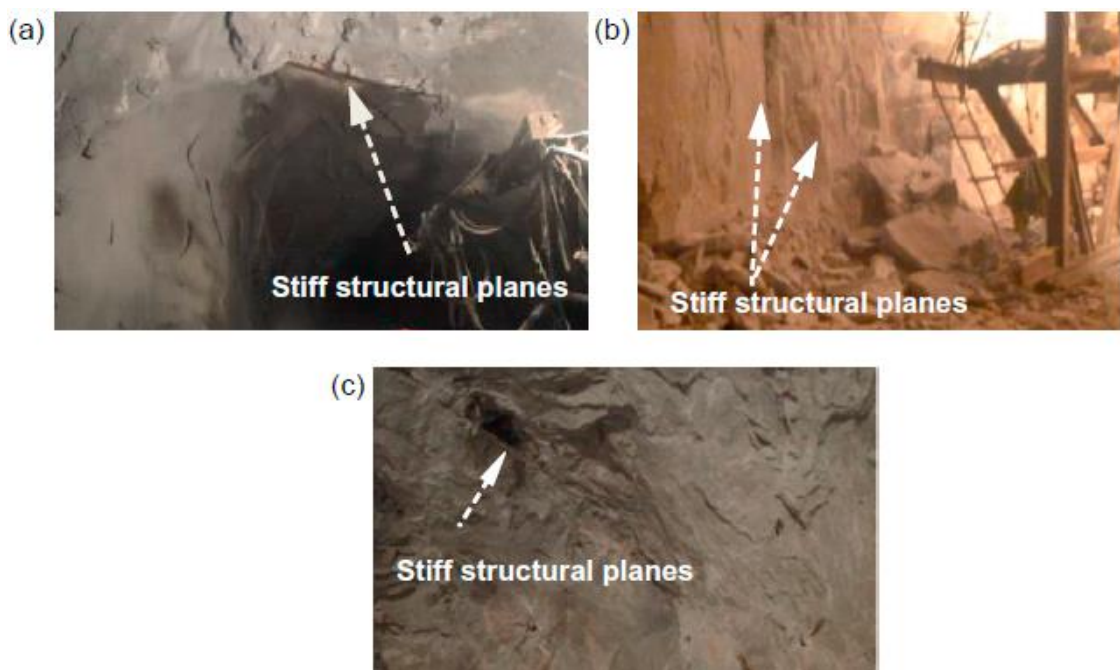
Ejemplos típicos de estallidos de roca en túneles de minería subterránea controlados por un plano estructural rígido o un set de planos estructurales rígido.
